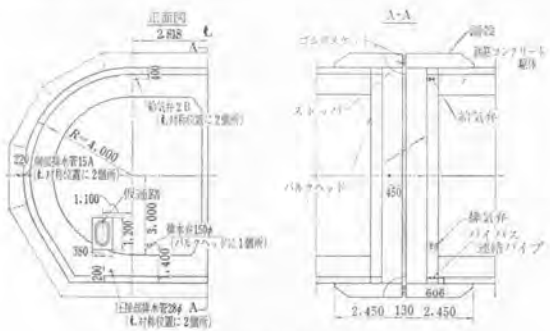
給気弁, 排水弁, 仮通路, 側部排水管, 圧接部排水管配置図
